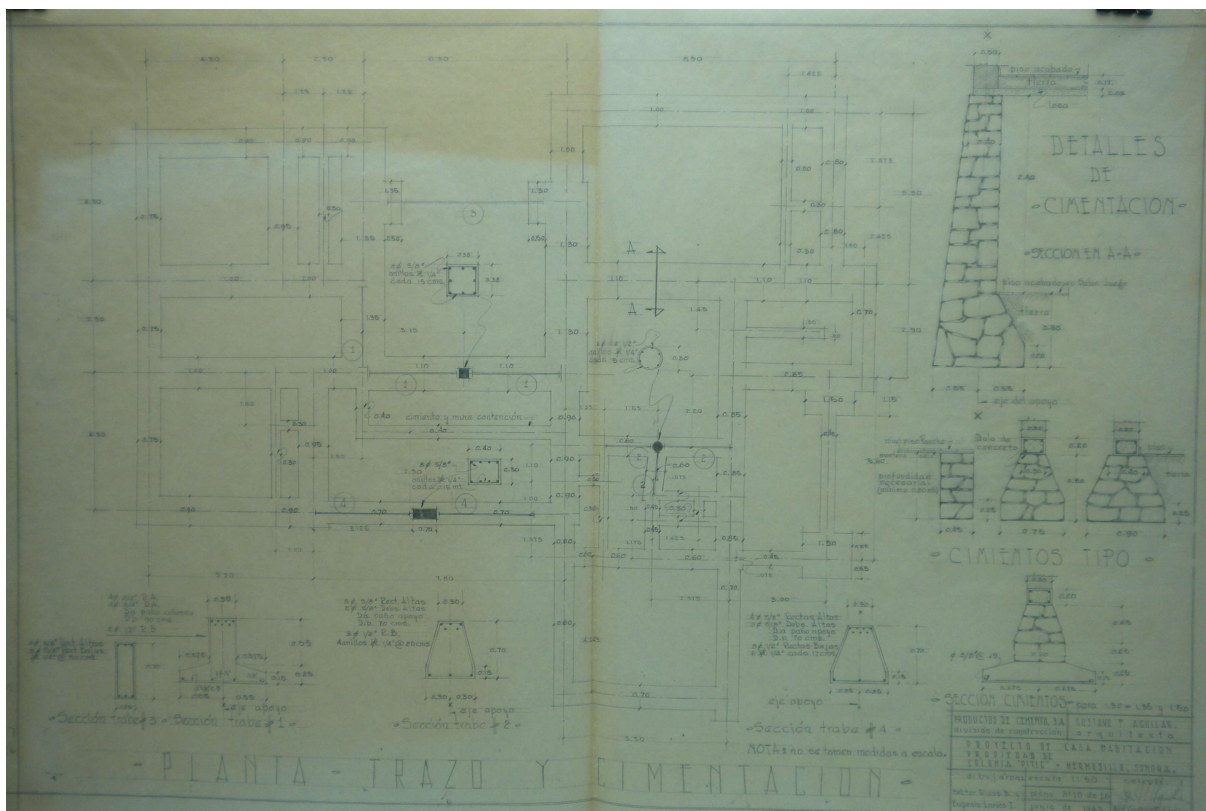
Plano de trazo y cimentación del proyecto de Casa habitación para el Sr. Ignacio Soto en la colonia Pitic, donde se observa el nivel por debajo de la planta baja.
